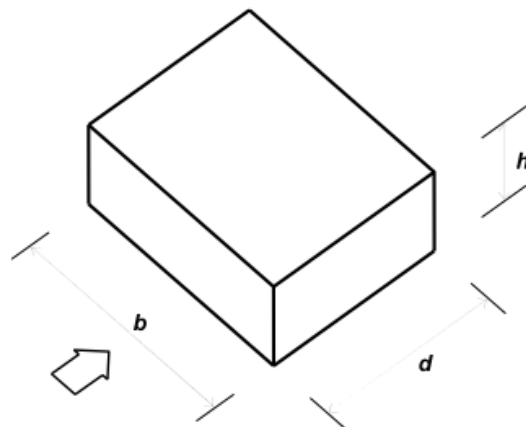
Parametri caratteristici di edifici a pianta rettangolare.
